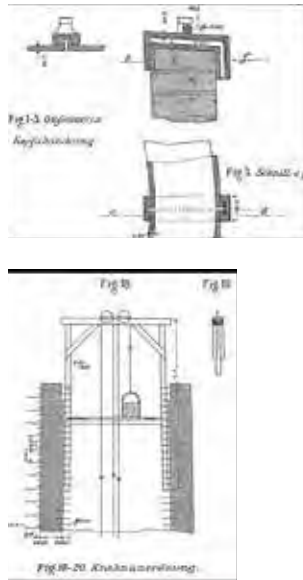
Ausschnitte aus Originalzeichnung und Foto vom Baubeginn
